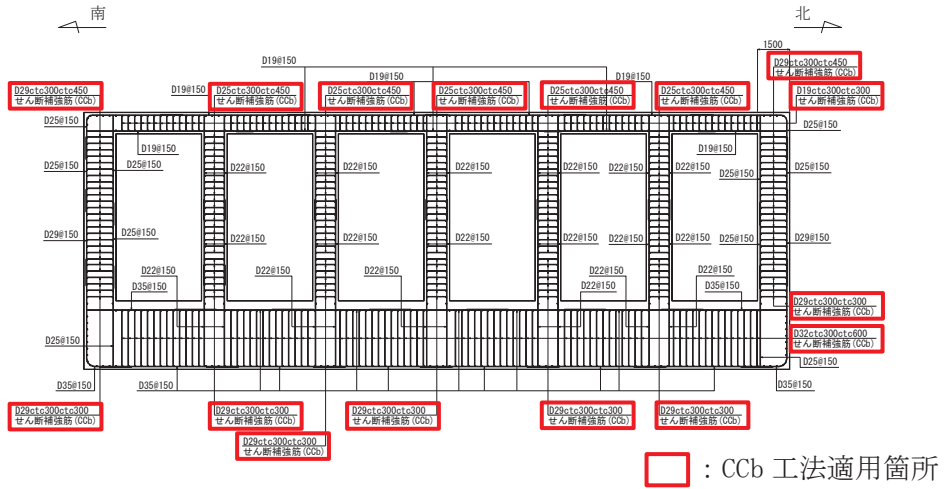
取水口概略配筋図 (A-A 断面, 標準部)
